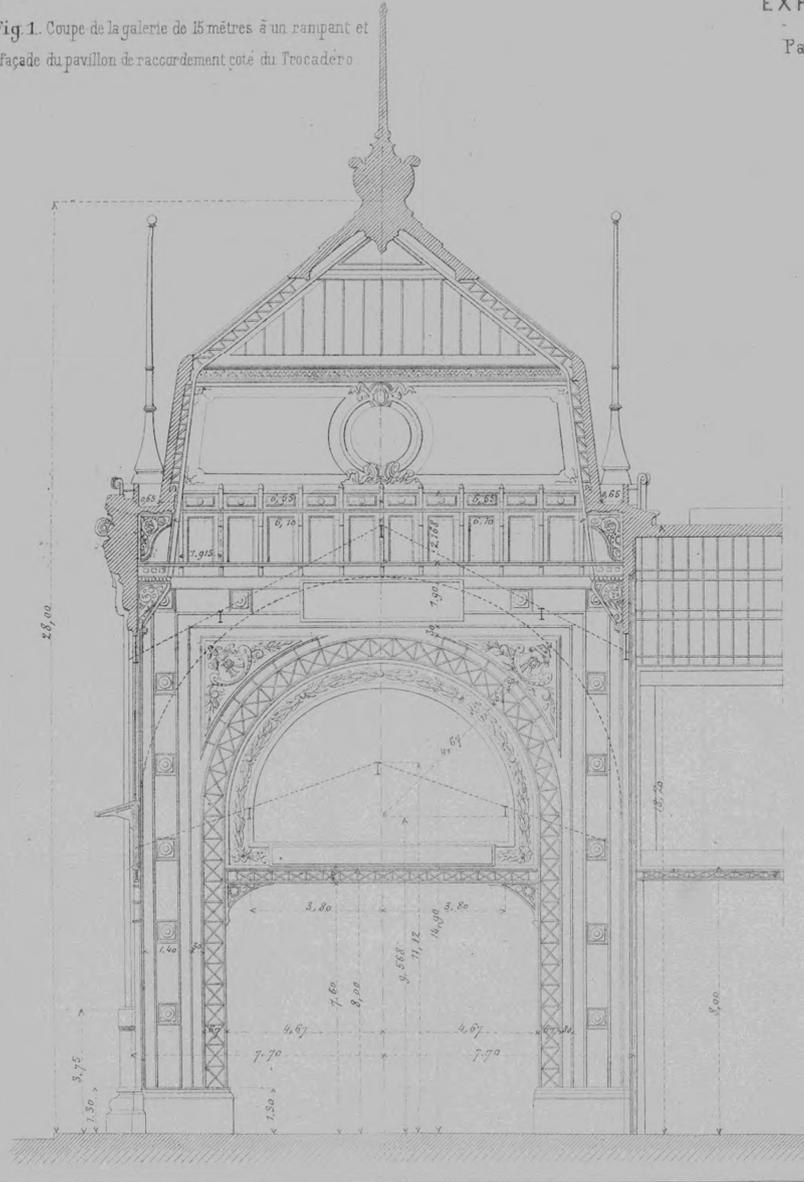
Coupe de la galerie de 15 mètres à un rampant et façade du pavillon de raccordement côté du Trocadéro.
